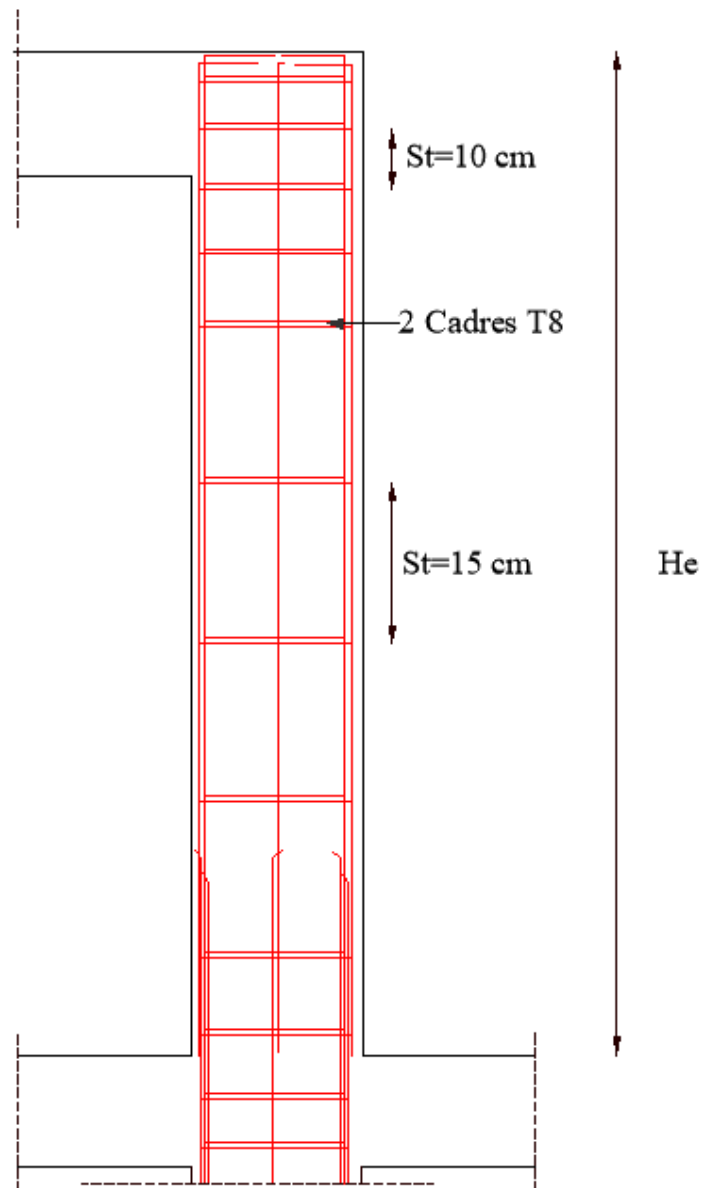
Schéma de ferrailage des poteaux (Coupe).
